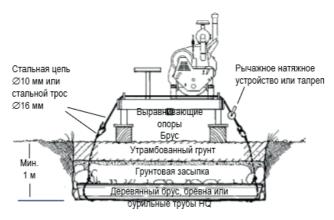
Регулировка натяжения троса (вид со стороны двигателя)
